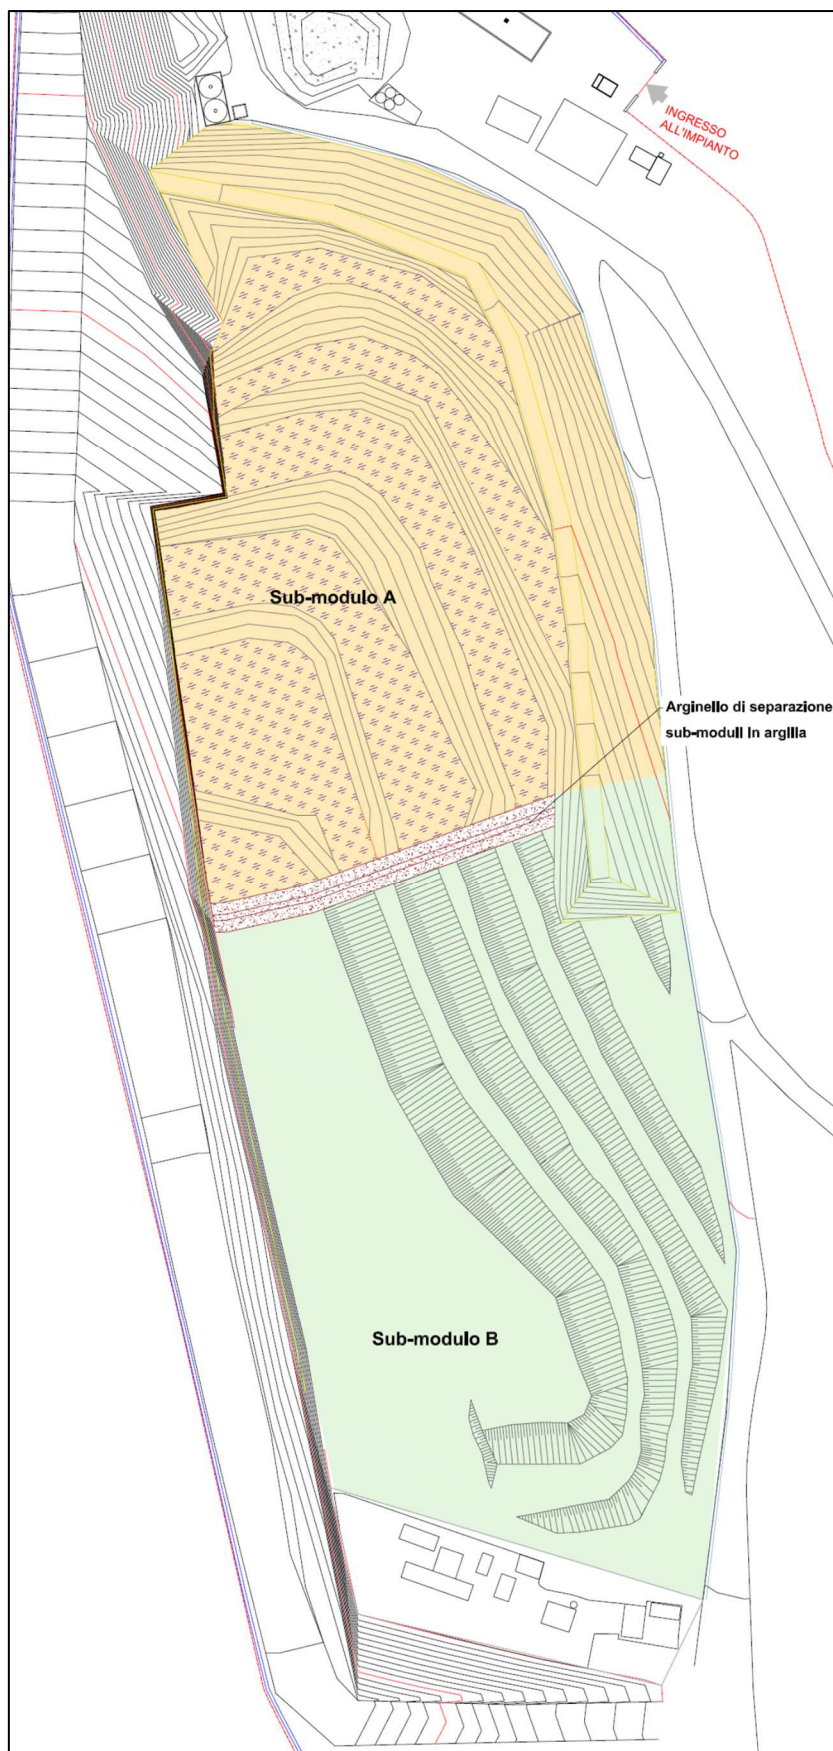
/XXV: Planimetria suddivisione sub-moduli
